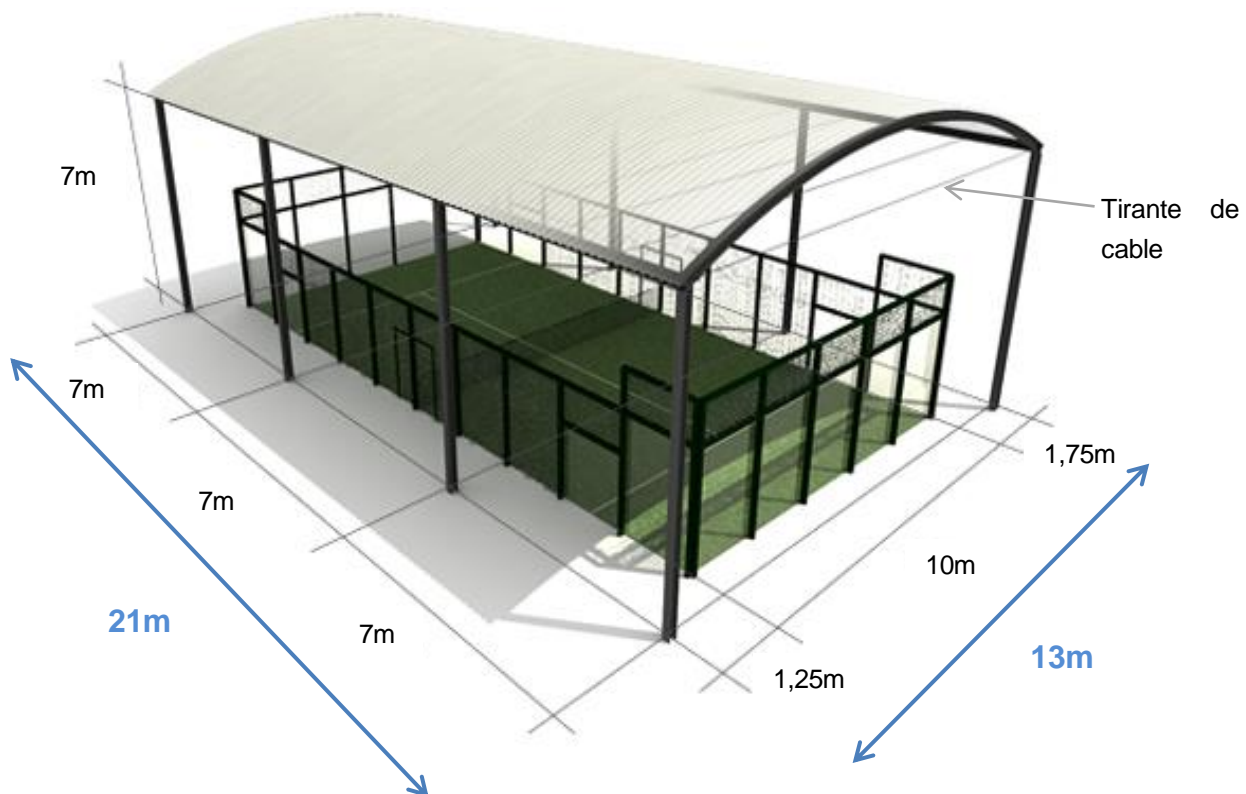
Esquema de las dimensiones de la estructura de cubierta de la pista de pádel.
